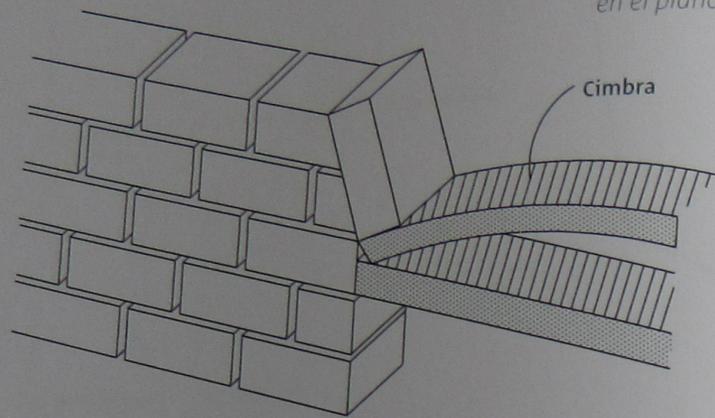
Asentamiento de los ladrillos en el plano inclinado
